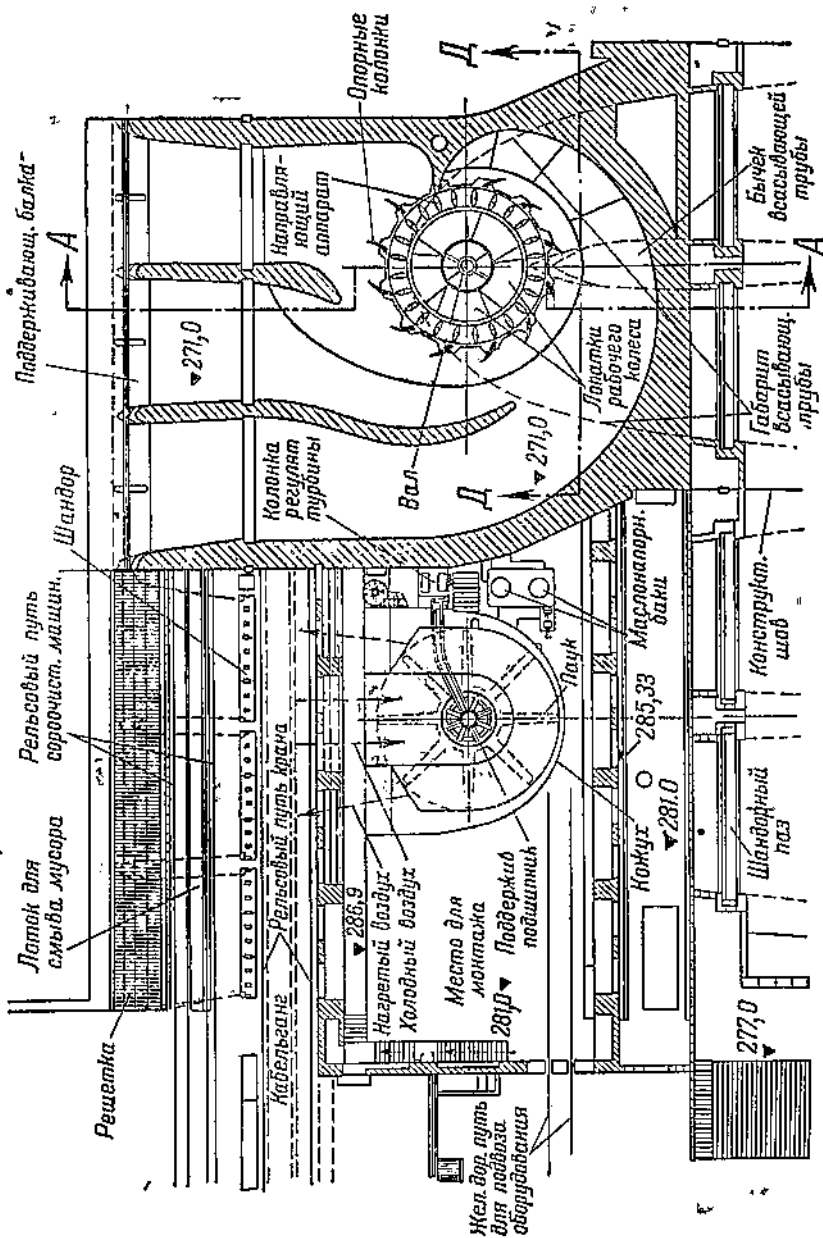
, а. Машинное здание гидроустановки, изображенной на фиг. 76. Поперечный разрез.
